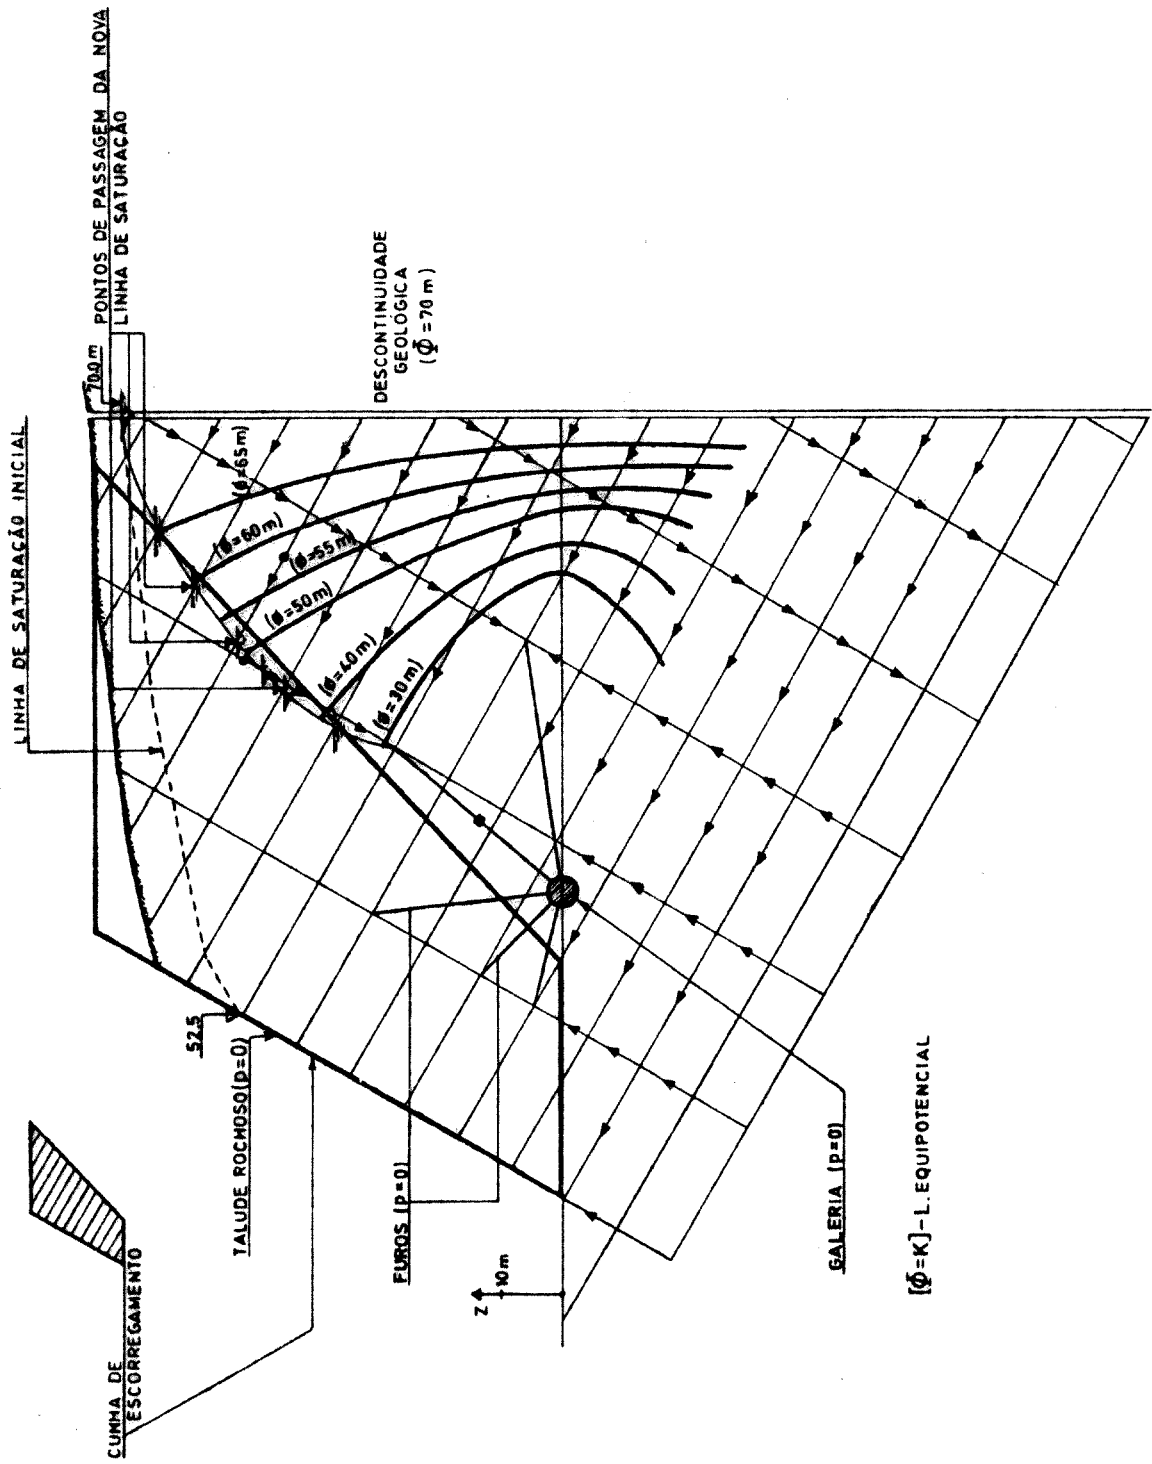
Drenagem do talude rochoso fissurado utilizando uma galeria e furos. Fácies do escoamento.
